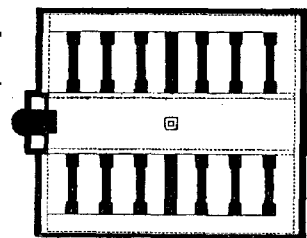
Схема больничного плана Французской Академии Наук (1788 г.).
